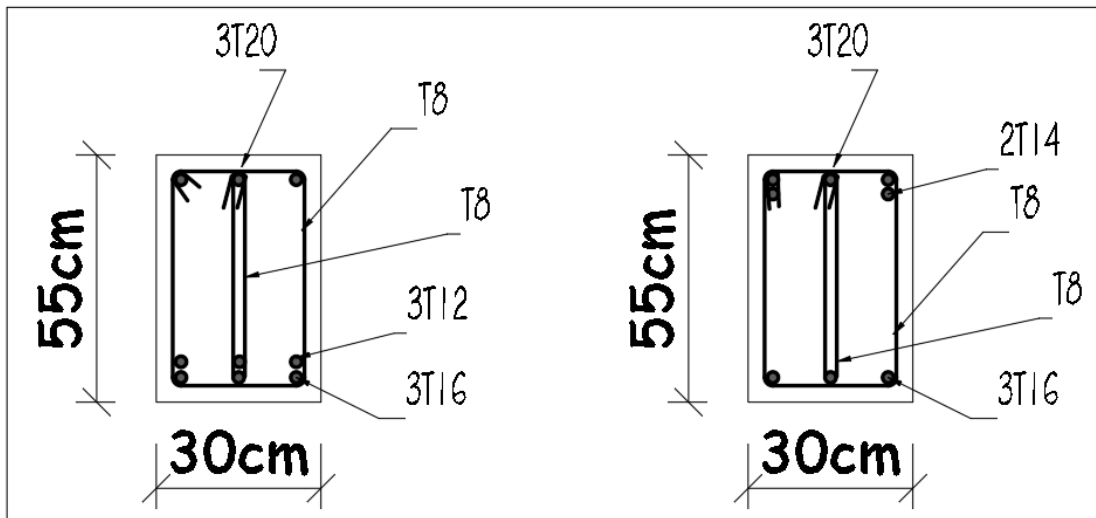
Ferraillage de la poutre principale de la terrasse
